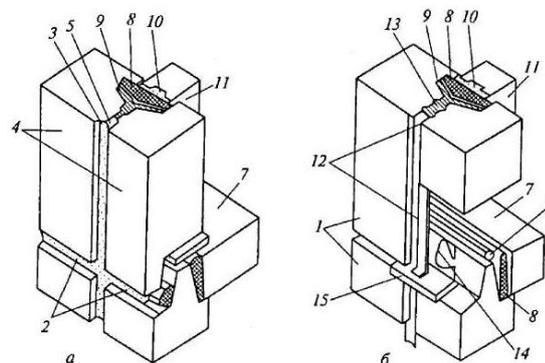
Стыки наружных крупнопанельных стен: а – вертикальные закрытые; б – вертикальные открытые.
